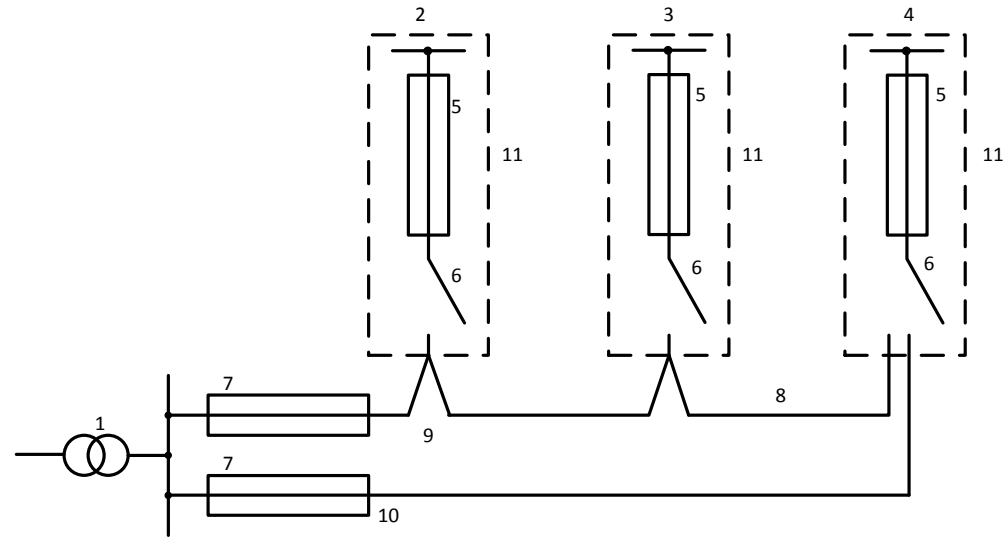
Принципиальная схема электроснабжения жилых домов высотой до 5 этажей с переключателями на вводах:
